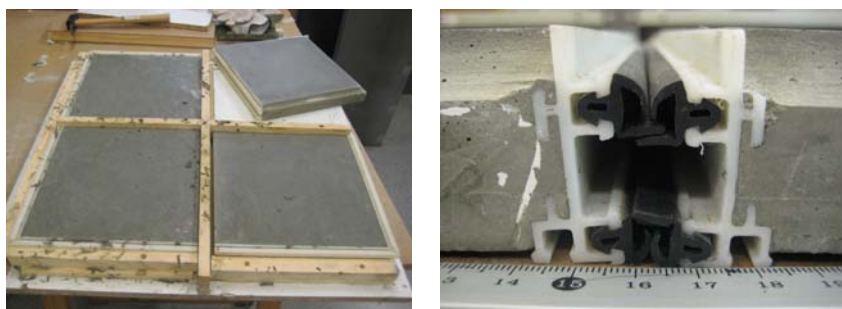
Molde con los perfiles perimetrales. Detalle de la pieza hormigonada
